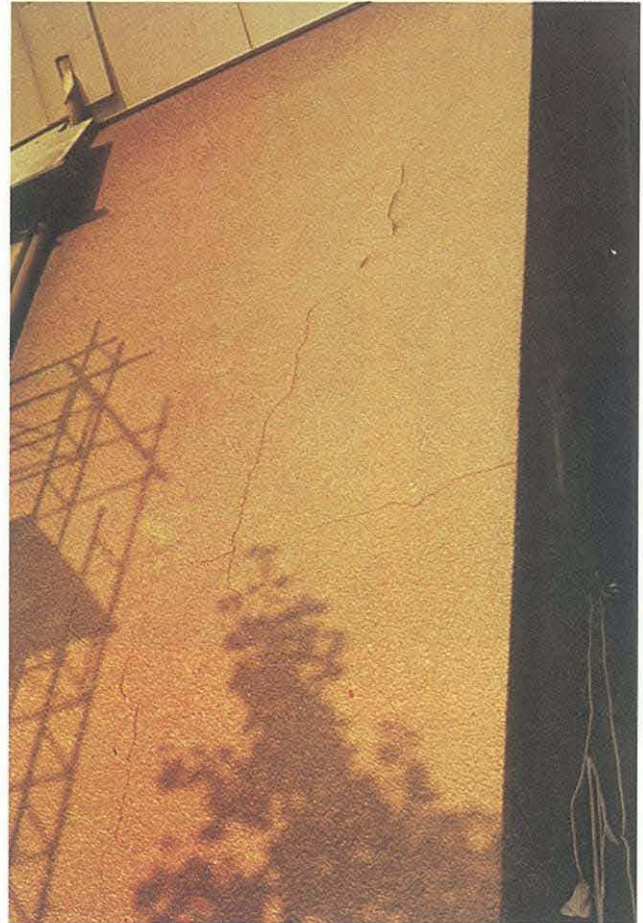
Horizontalriß in Höhe der Decke über dem Brandraum und daran anschließende Vertikalrisse
